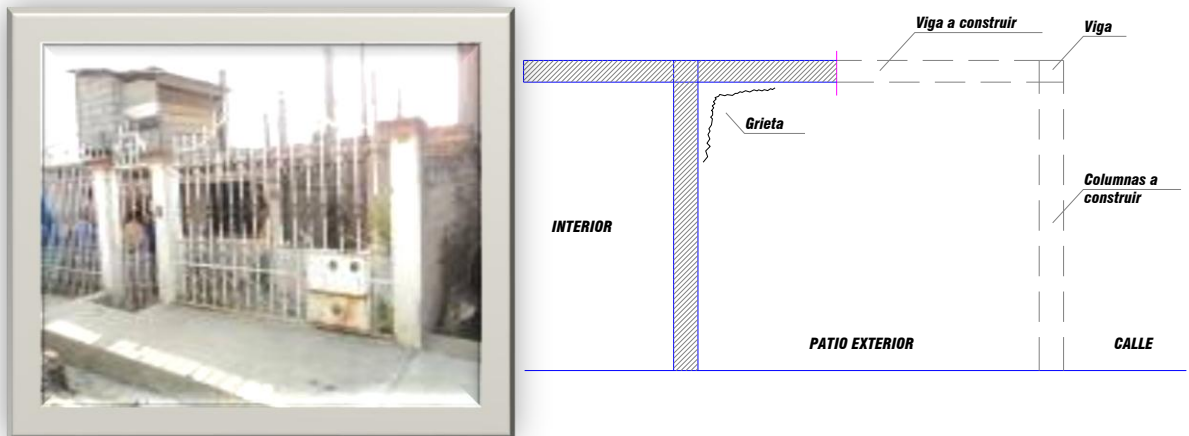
FALLA EN MAMPOSTERÍA DE CERRAMIENTO
